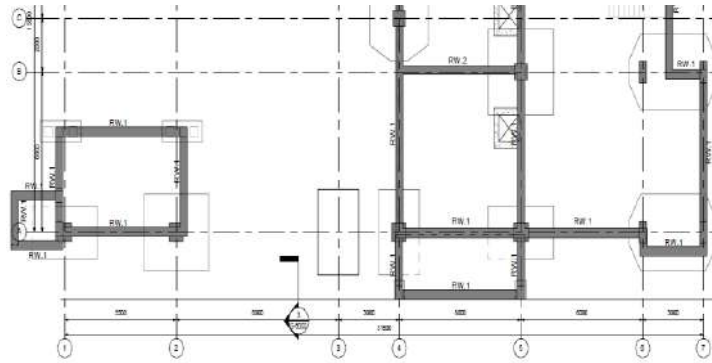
Pekerjaan Kolom Pada Dinding Beton
